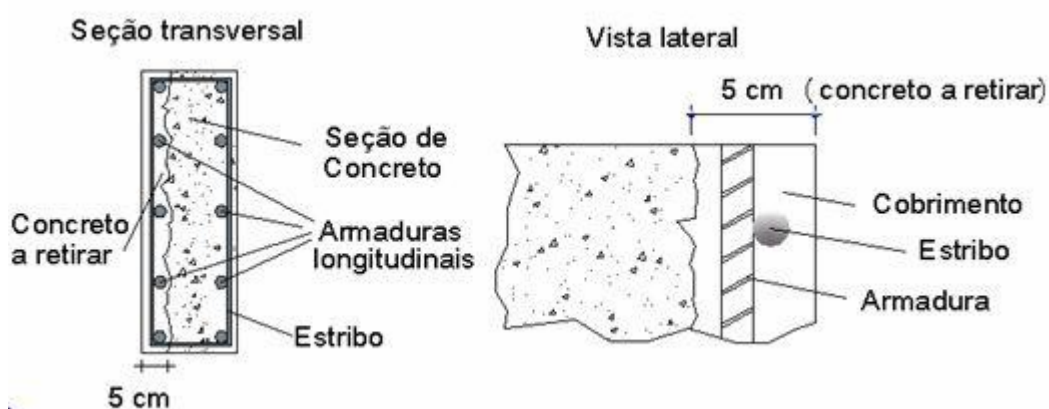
Representação esquemática da profundidade de remoção de concreto deteriorado no pilar.
